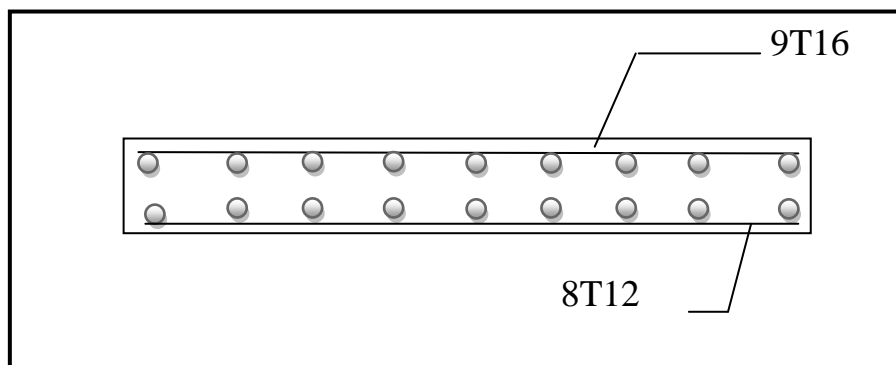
Schéma de ferrailage de mur de soutènement.
